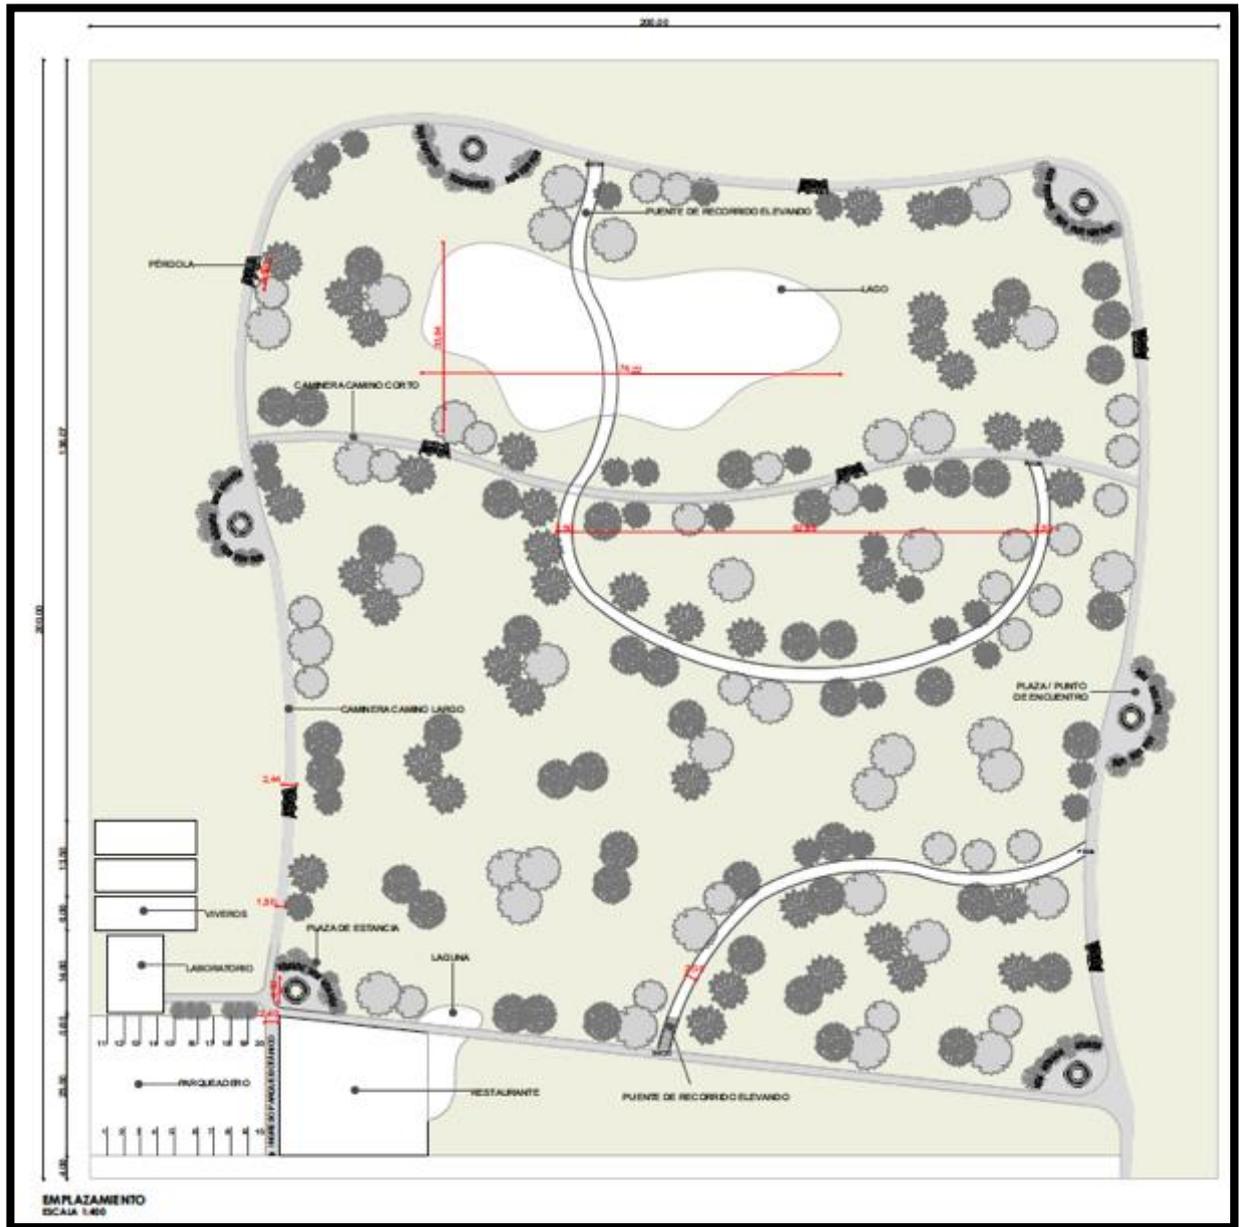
Vista de planta parque botánico (zona de turismo)
